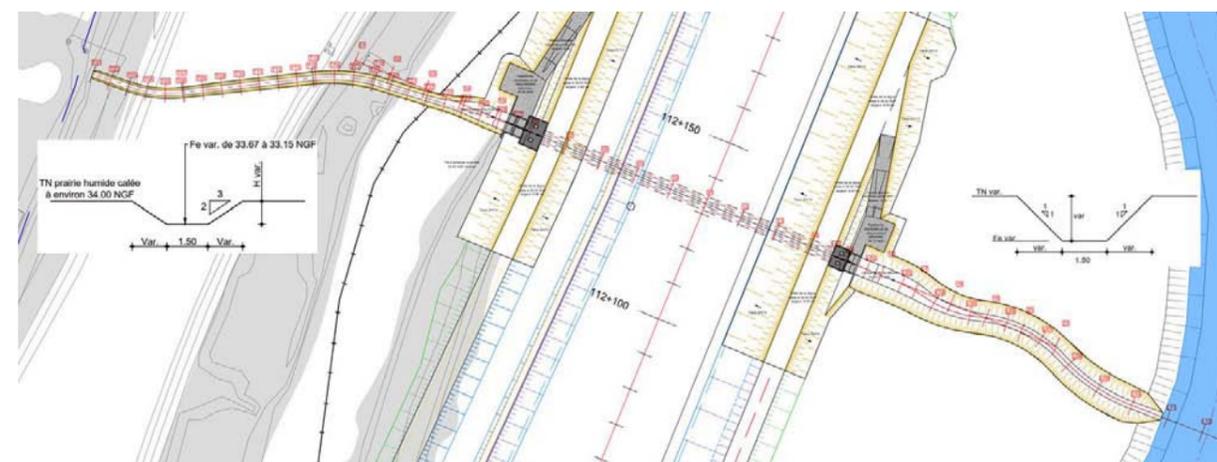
Vue en plan et profils en travers type du ru du Moulin
